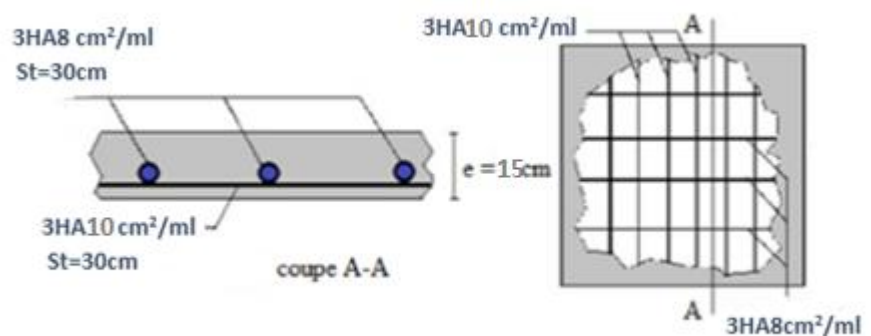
Schéma de ferrailage de la rampe d'accès et des parkings
